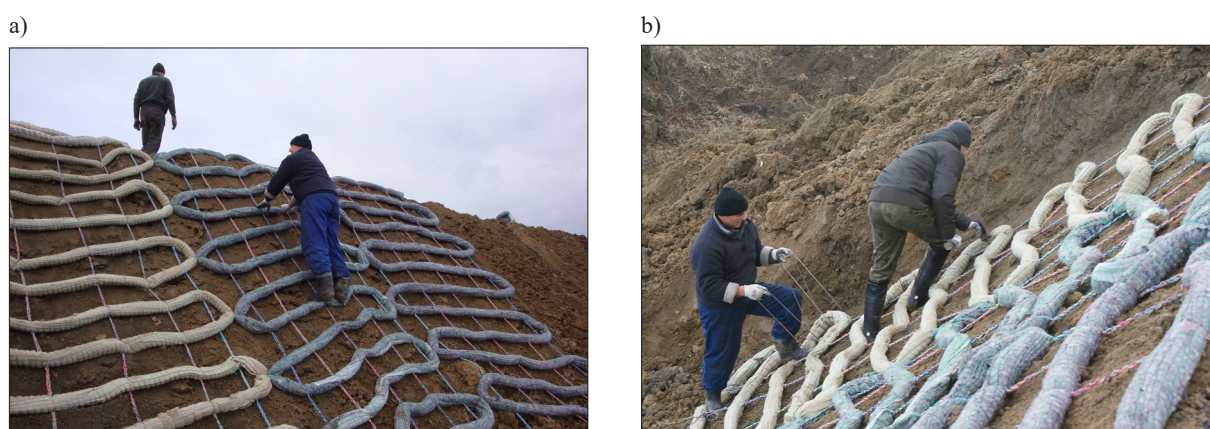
Prace przygotowawcze poprzedzające zainstalowanie geotekstyliów:
